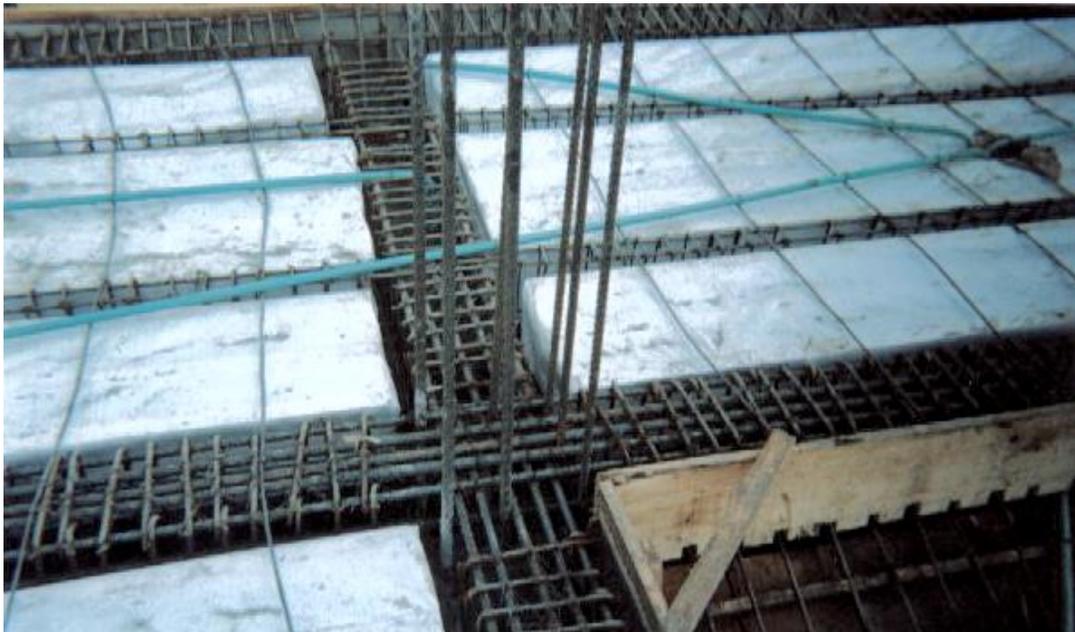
Armado de vigas aéreas y pega de mampostería primer piso
